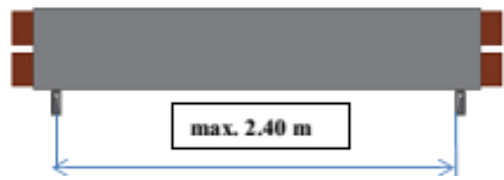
Схемы обвязки при помощи текстильных строп на строительной площадке
